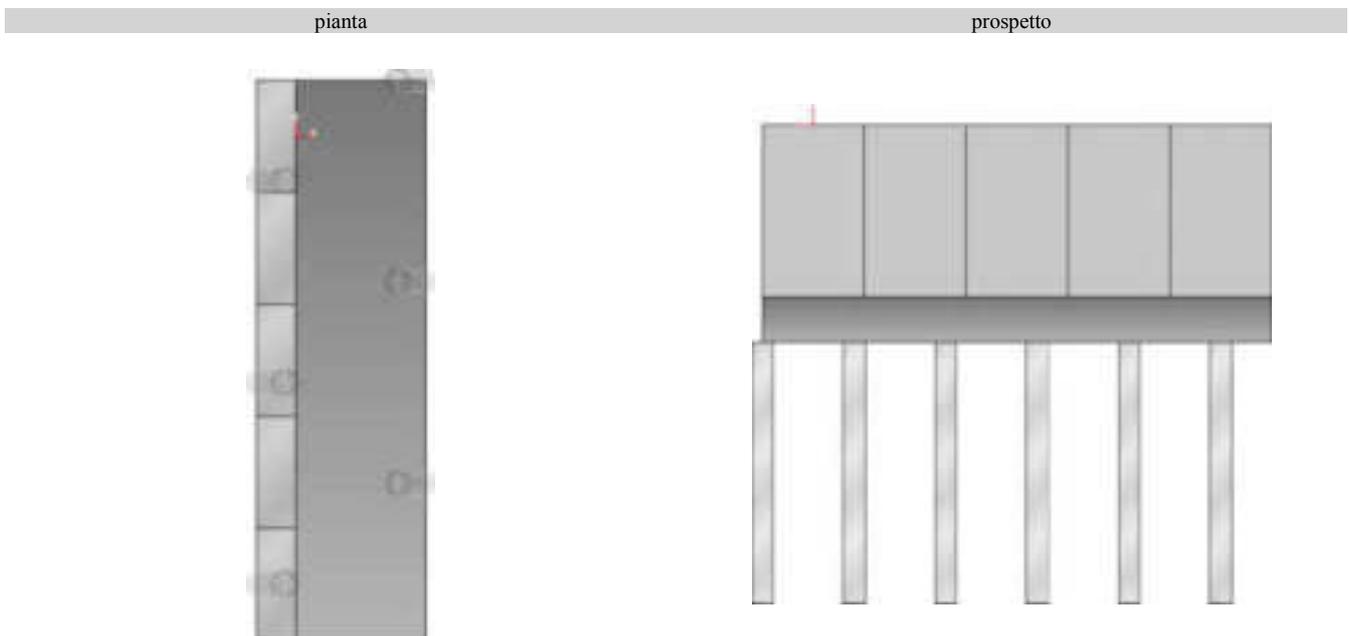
Pianta e Prospetto Modulo Tipo
